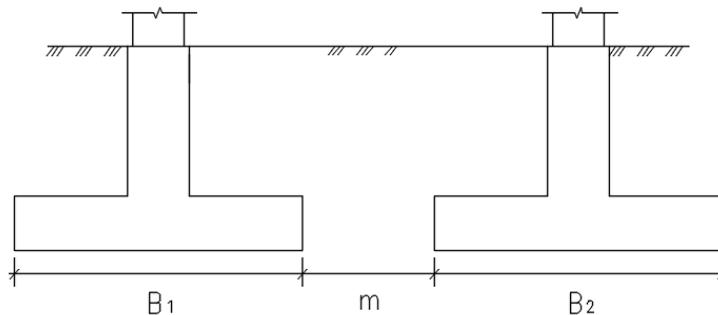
Separación entre zapatas en un mismo sistema. Fuente: Autores
